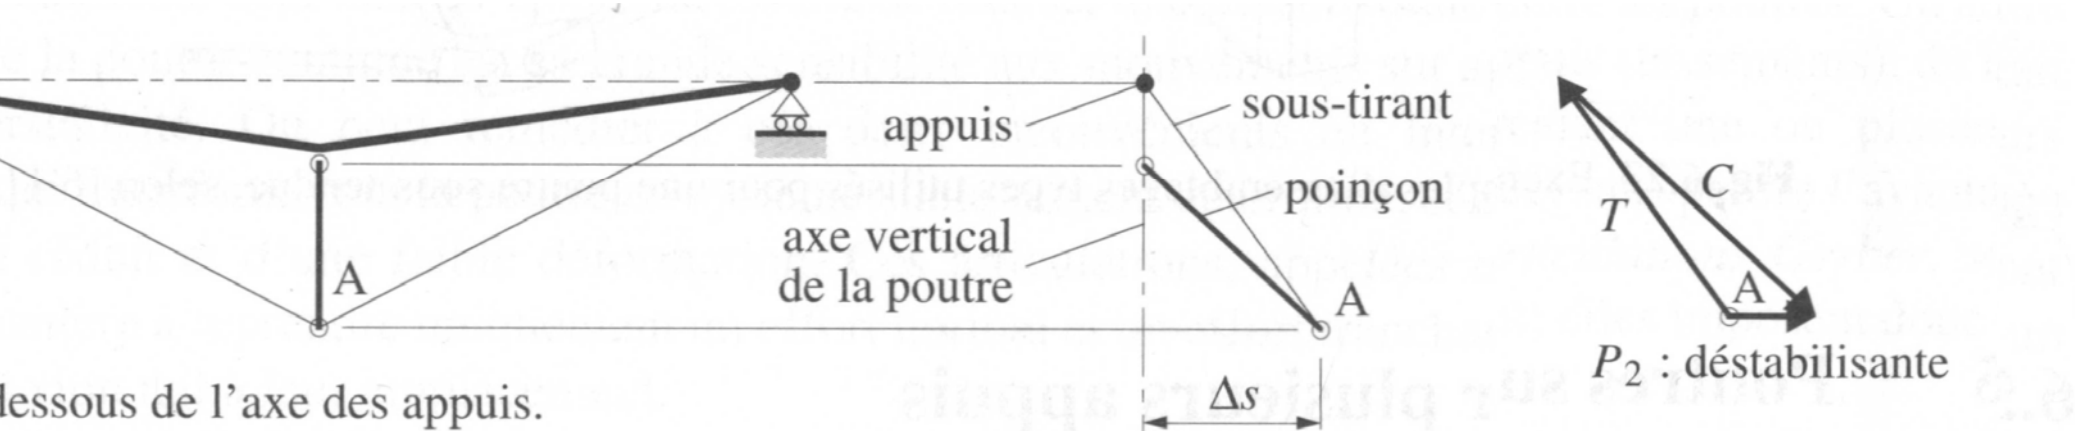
Poutre sous-tendue: mise en évidence des forces stabilisantes ou déstabilisantes dans le cas d'une poutre de base brisée.
